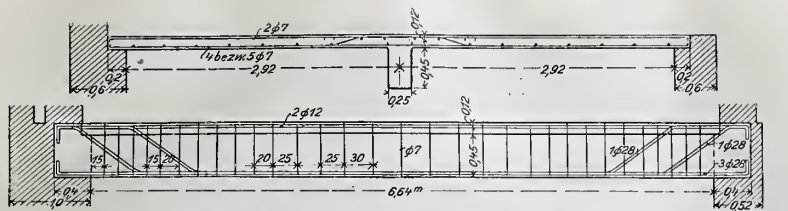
Gewöhnliche Eisenbeton-Deckenplatte mit Unterzug.
